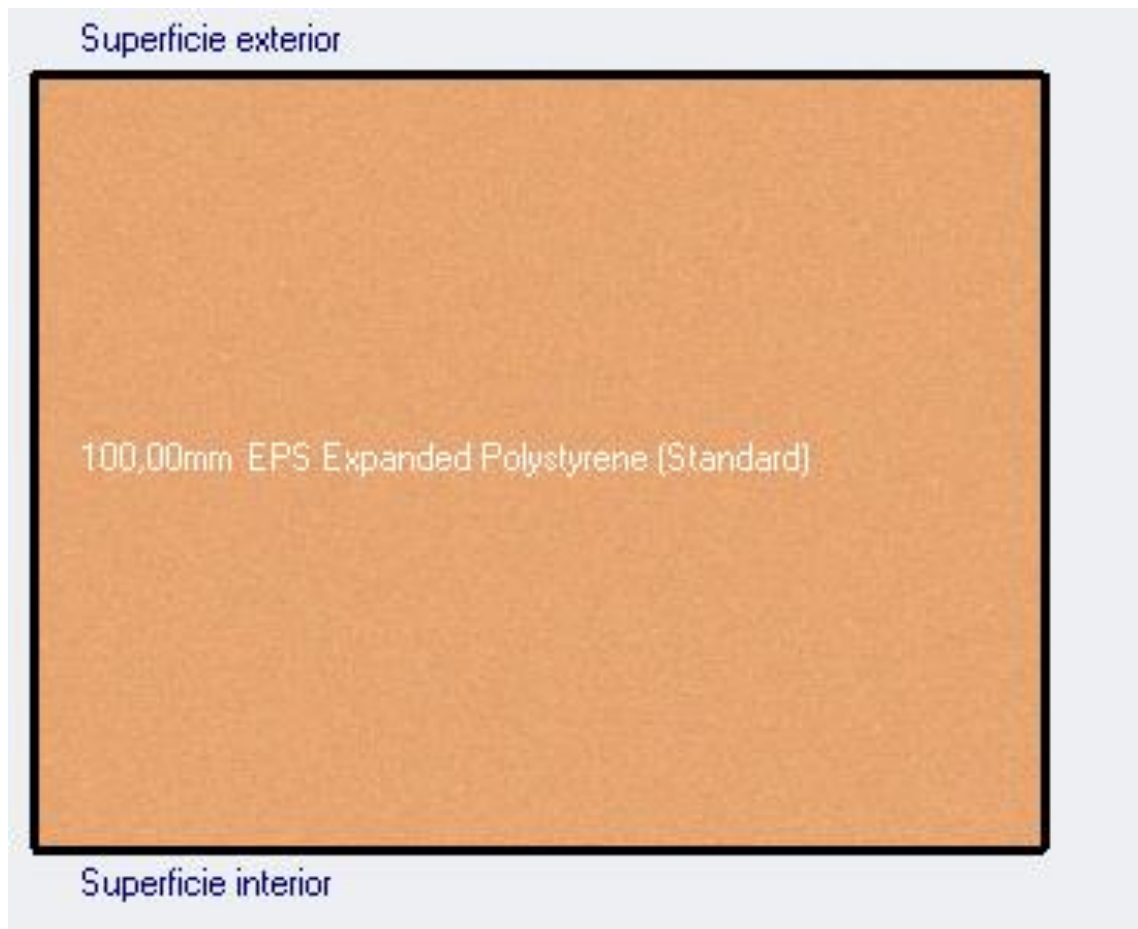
Solución térmica en cubierta. Fuente: Fuente: Elaboración propia Design Builder
